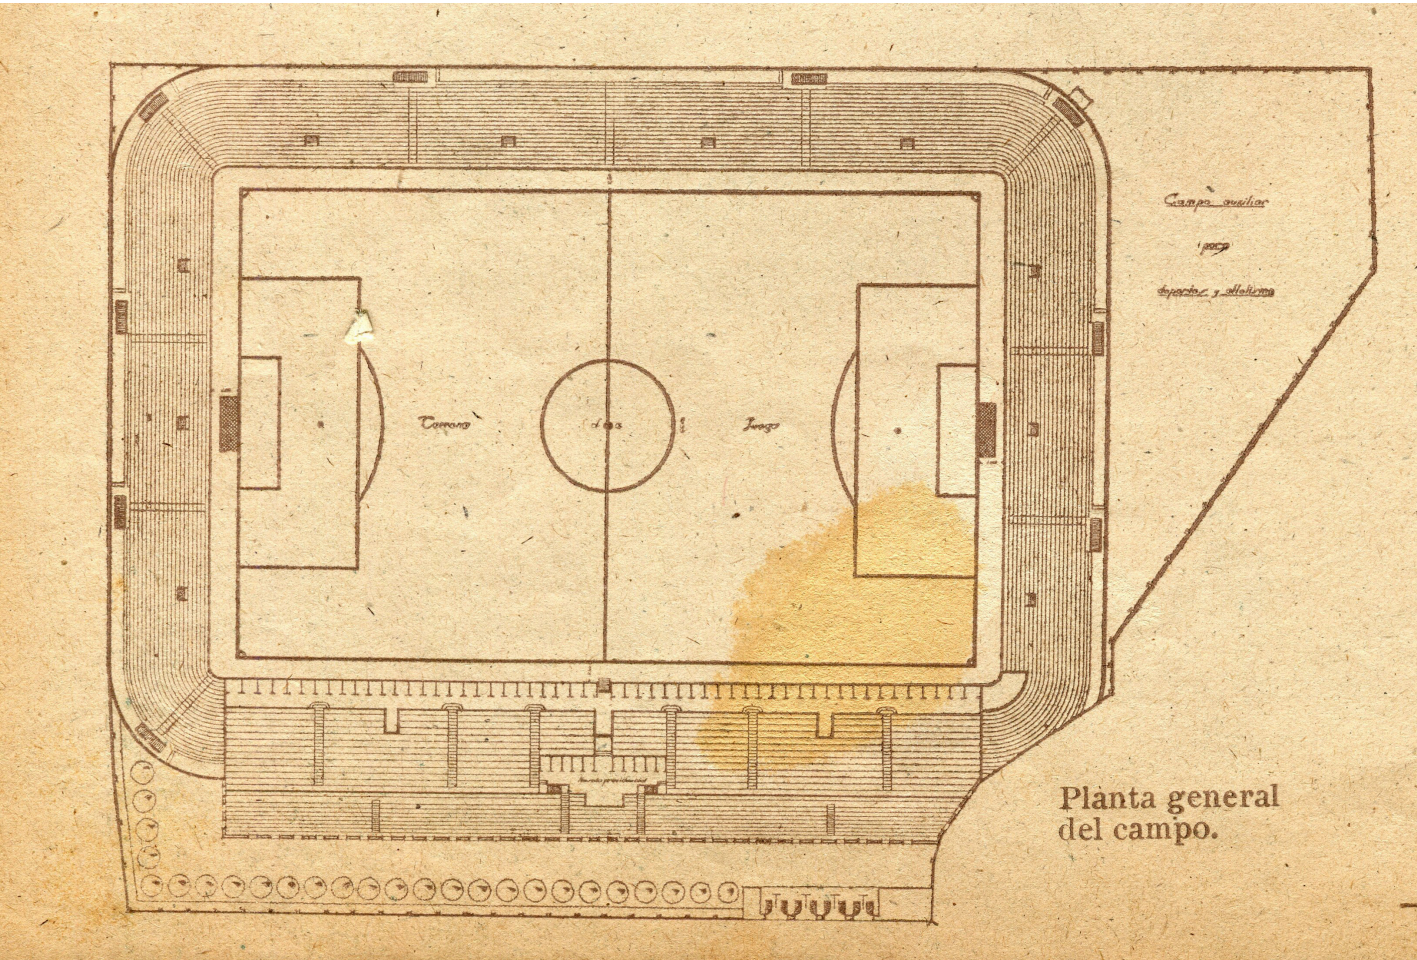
Planta de la reconstrucción del Campo de Mestalla de 1939.
